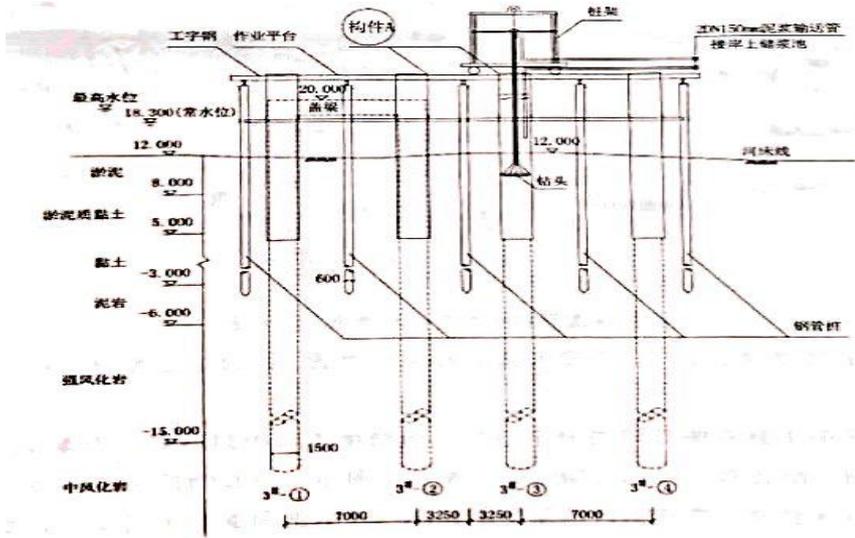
3#墩水上作业平台及桩基施工横断面布置示意图
